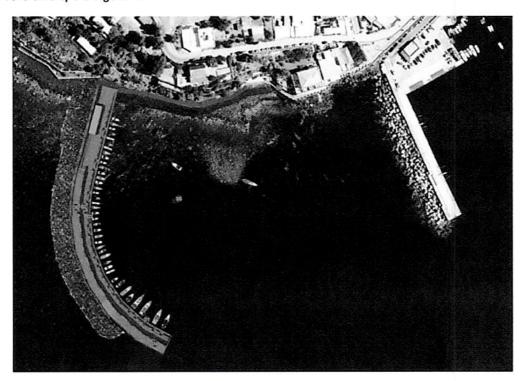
Vista dall'alto dell'opera in progetto (1° stralcio)
